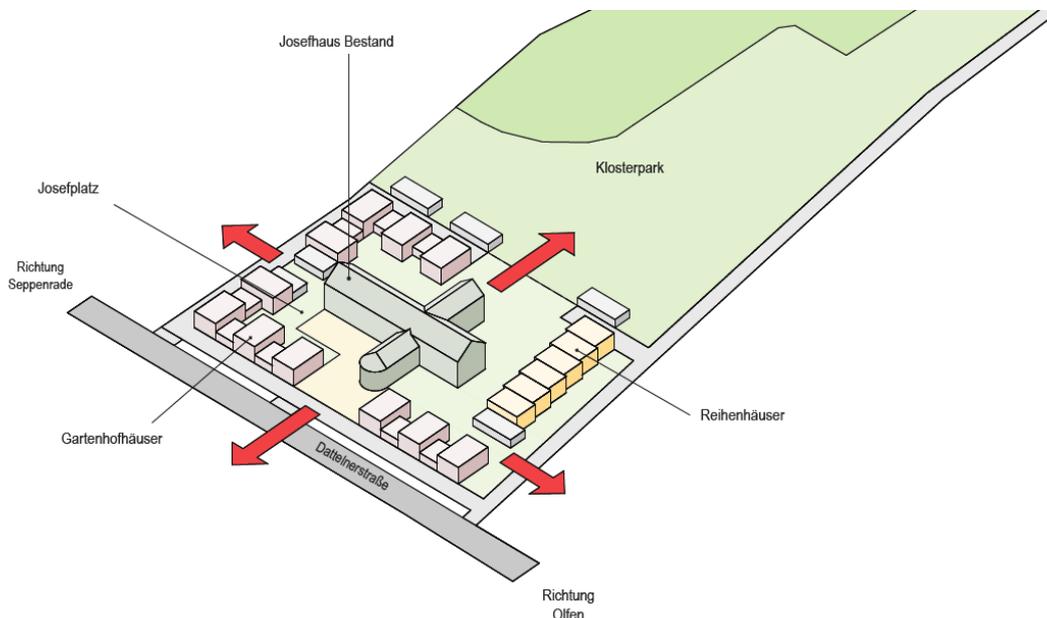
Städtebauliche Prinzipskizze (Röing genannt Nölke Architekten)
